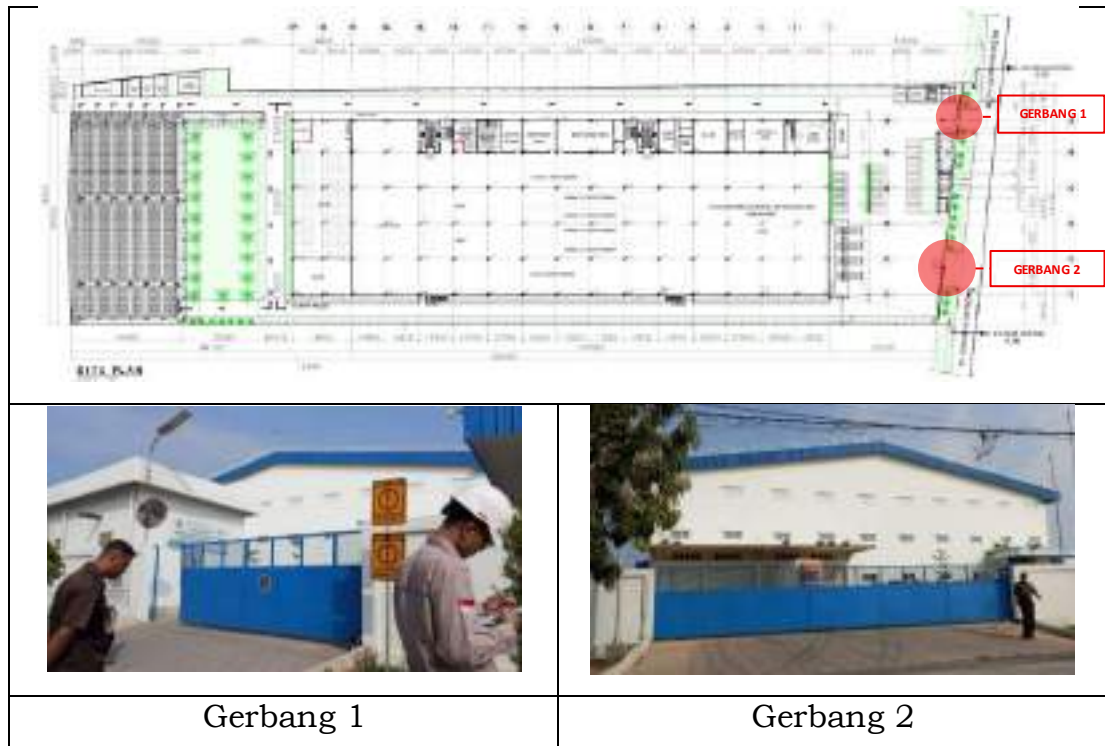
10 Ketentuan Sempadan dengan Site Plan
